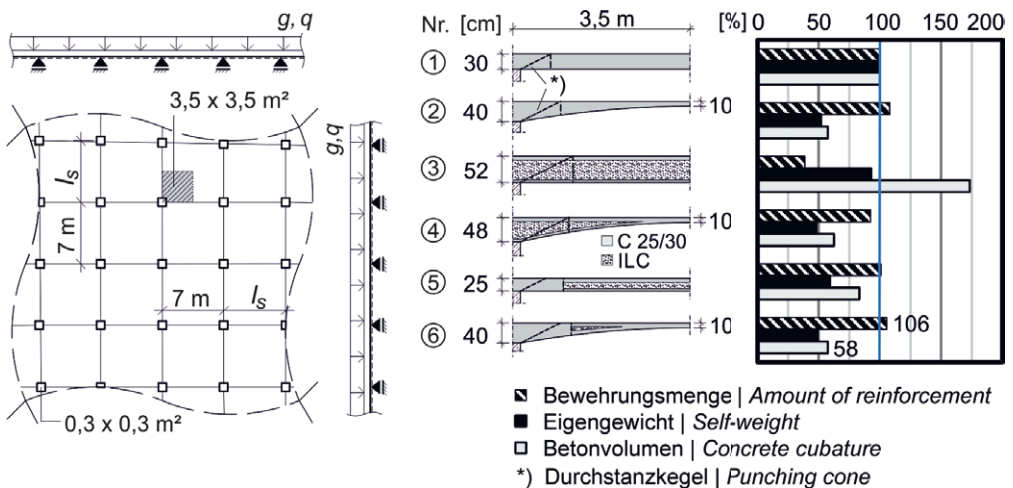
Punktgestützte Durchlaufdecken; links: statisches System, rechts: Massen-/Mengenvergleich verschiedener Deckenausbildungen | Fig. 7: Structural system of a point supported multi-span slab (left) and mass/quantity comparison of different ceiling designs (right)
